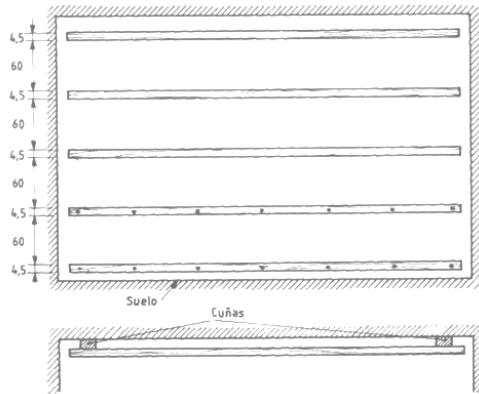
Colocación de Rastreles, en elevación y en planta.
